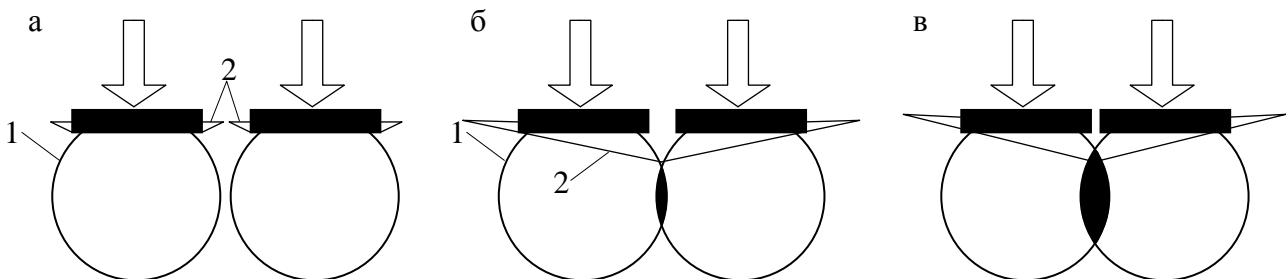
Взаємний вплив двох фундаментів: а – зони напружень не перекриваються; б, в – зони напружень перекриваються; 1 – зона напружень; 2 – вирва осідання
